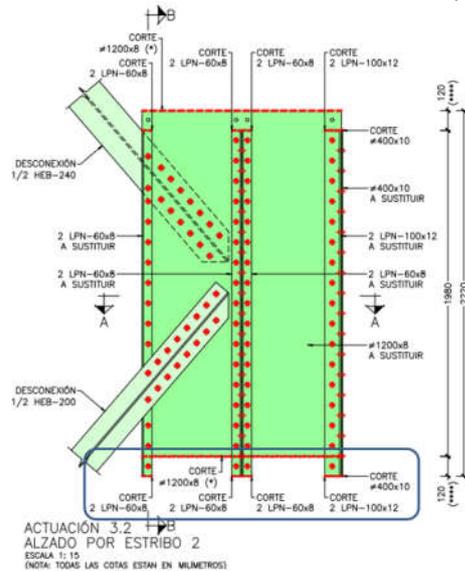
Nudo intermedio mamparo estribo 2. Corte de chapa de fondo
